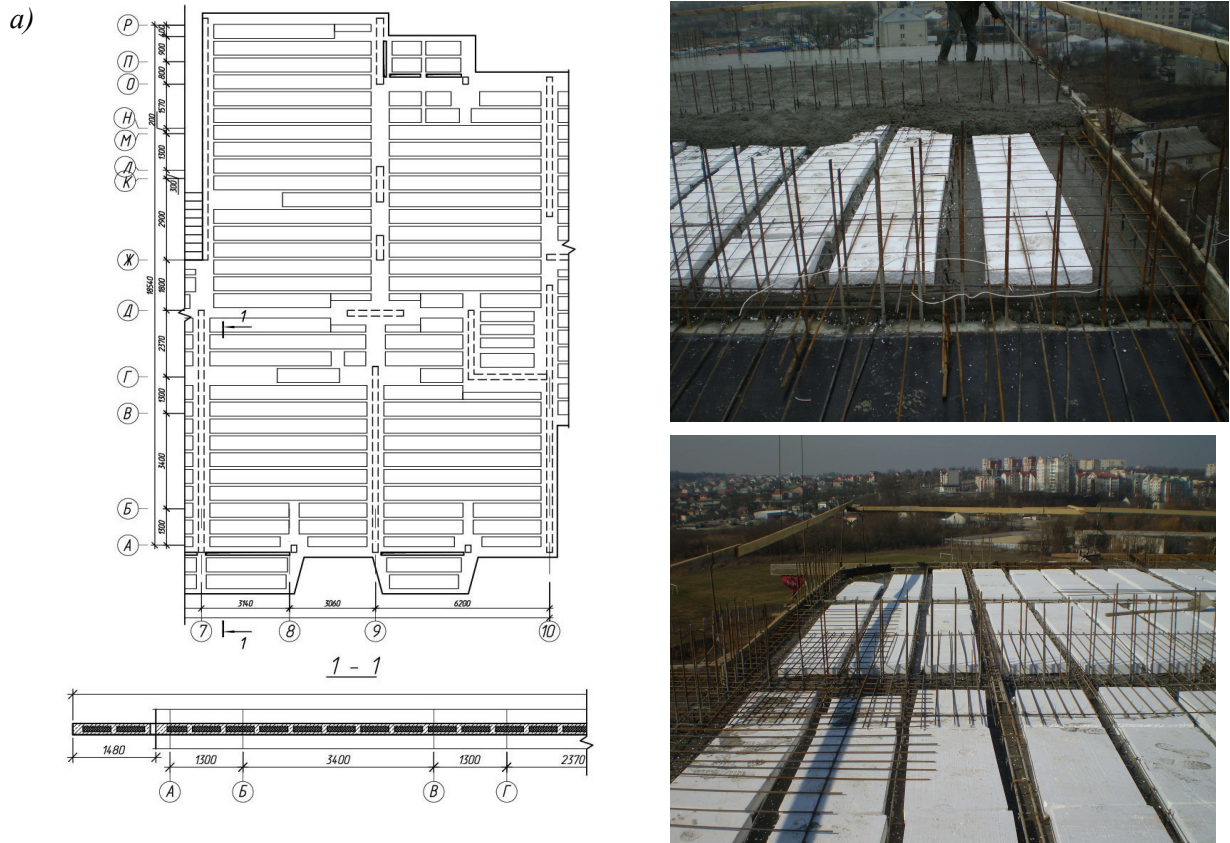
Розташування вставок в плані і в перерізі фрагменту перекриття будинку №3(а), розкладання вставок і арматурних виробів (б) та бетонування перекриття (в).
